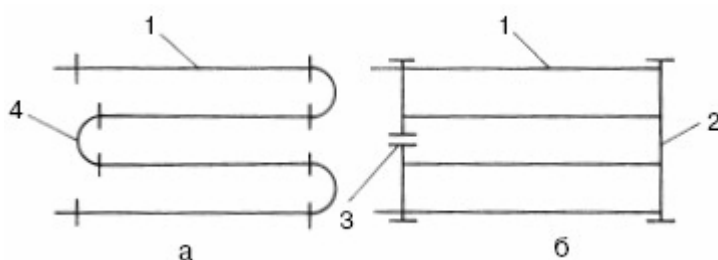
Схемы соединения стальных труб в гладкотрубные отопительные приборы: а – змеевиковая форма; б – регистровая форма; 1 – нитка; 2 – колонка; 3 – заглушка; 4 – калач
